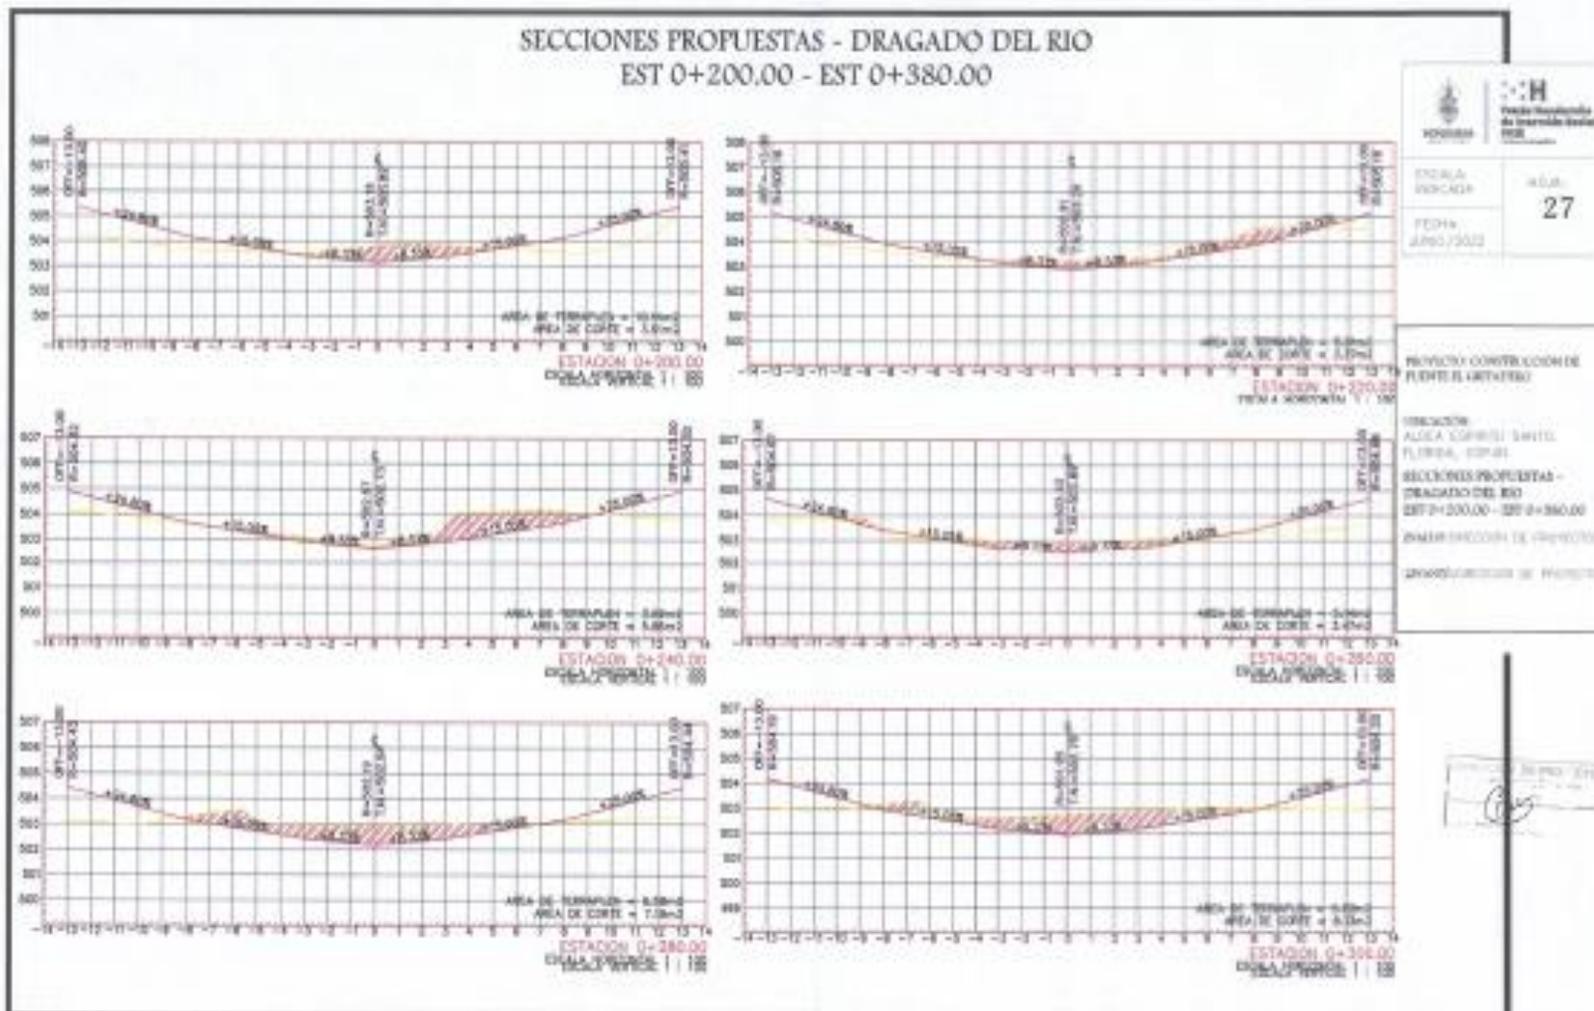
Secciones propuestas para dragado de río 0+200- 0+380
